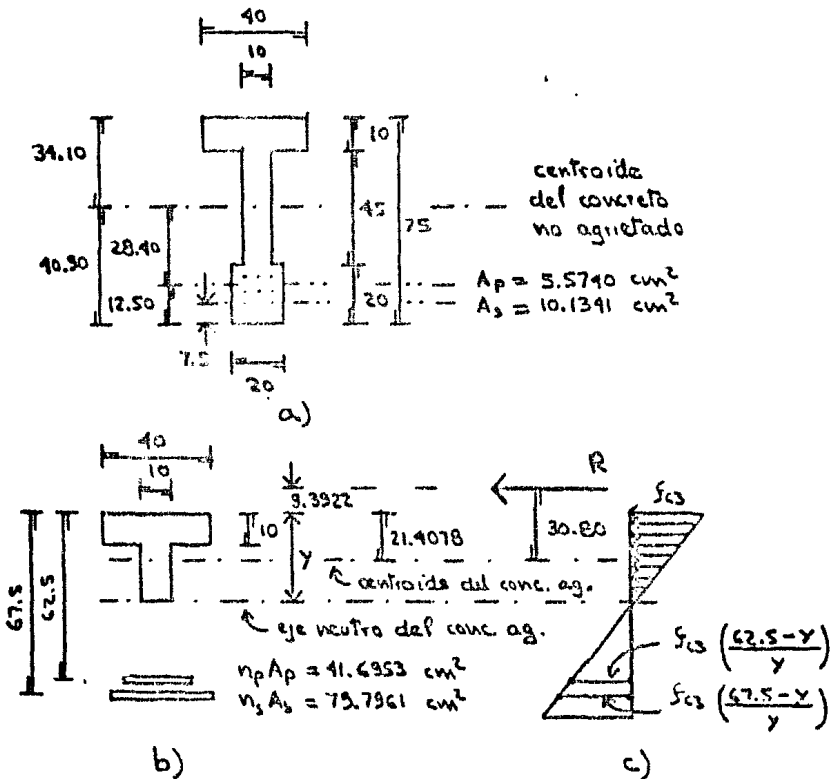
Análisis de la sección agrietada de una viga T. a) - Sección transversal del elemento. b) Sección transversal transformada agrietada. c) Esfuerzos en el concreto y en el acero.
